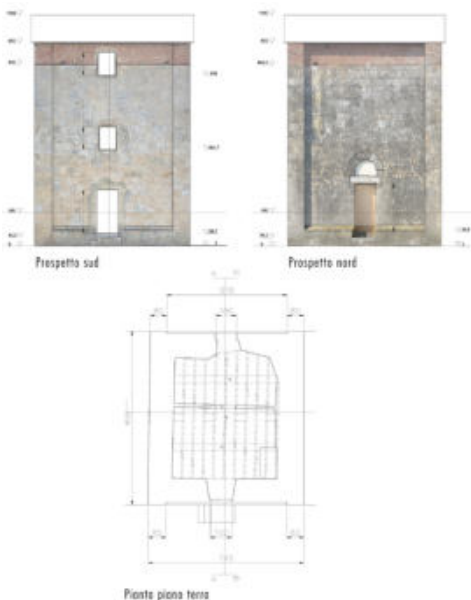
Pianta e prospetti della torre di Tabbiano con fotoraddrizzamenti (rilievo e restituzione grafica dell'autrice)
